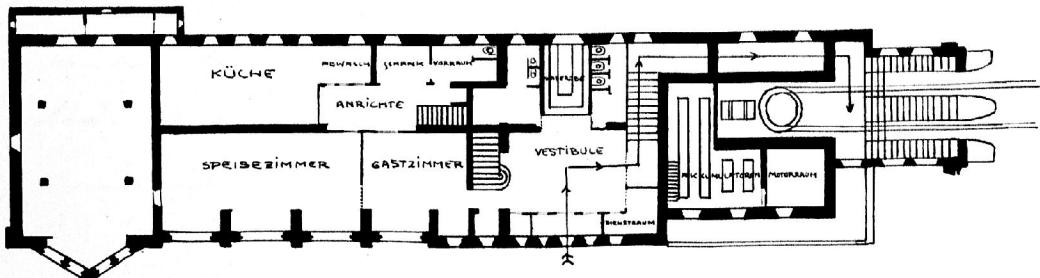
ERDGESCHOSSGRUNDRISS DER BERGSTATION
